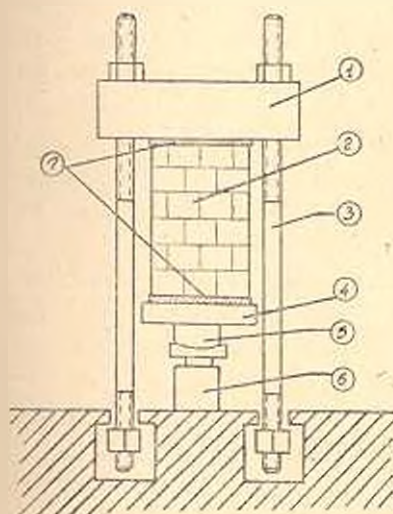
Схема испытания образца кладки на силовом стенде. 1—траперс; 2—образец; 3—стойки; 4—опорная плита; 5—сферический шарнир; 6—гидравлический домкрат; 7—алебастровые подушки.
